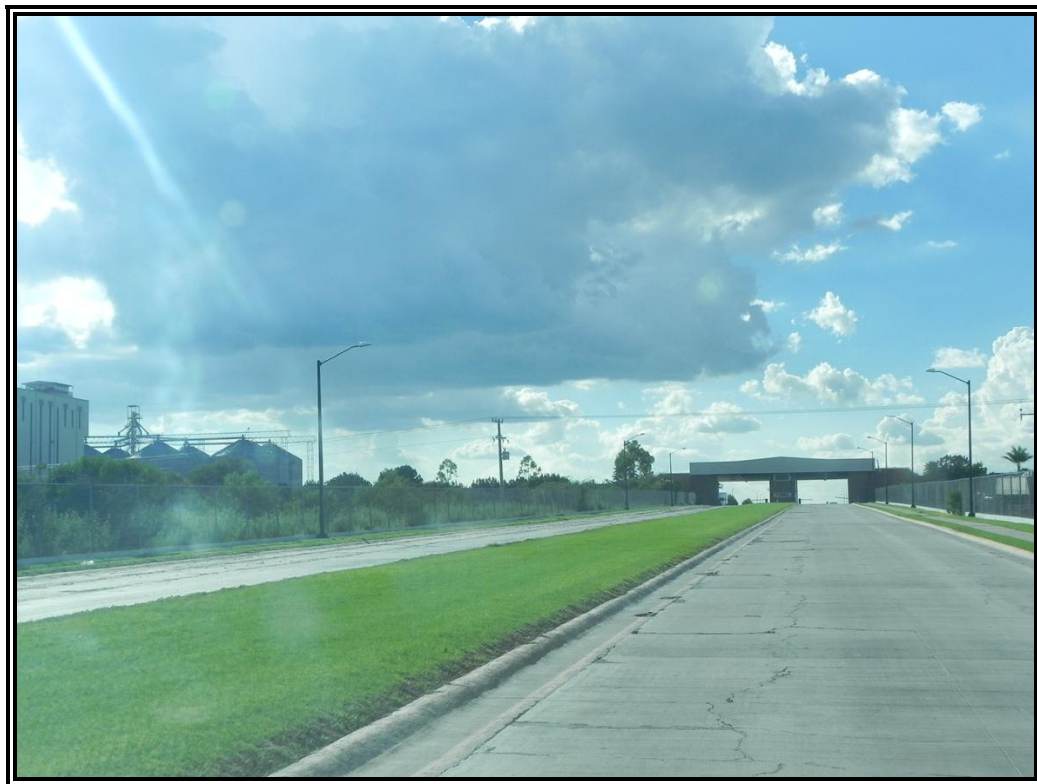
Vista del Libramiento Periférico por donde quedará instalado el gasoducto de 8".
